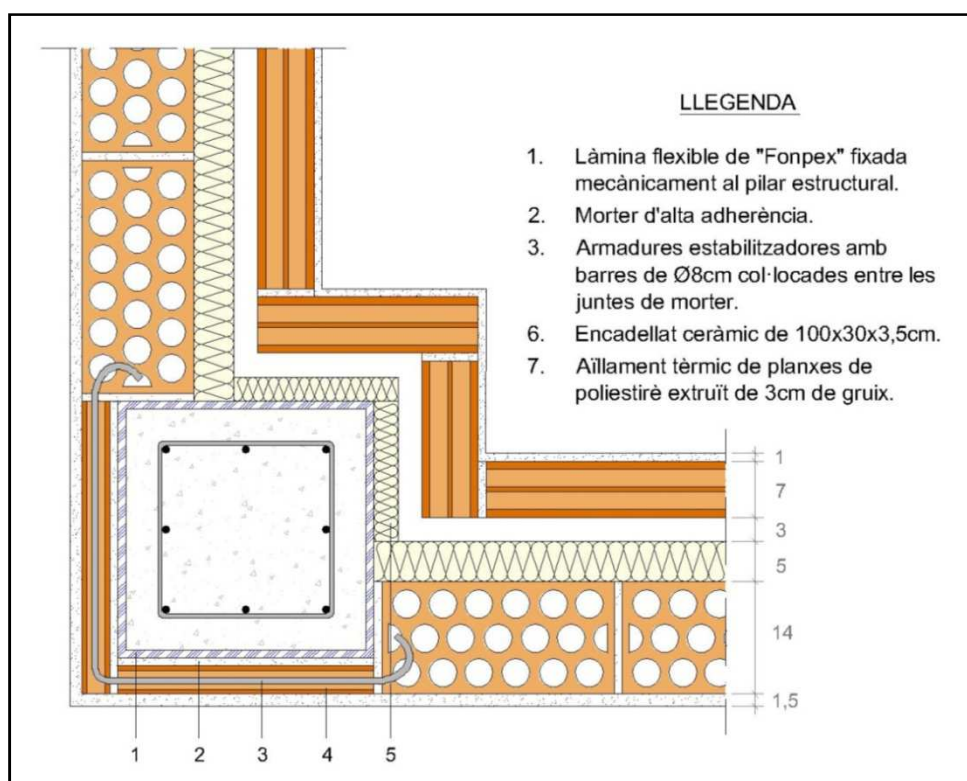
Pilar en cantonada del tancament d'obra per revestir
